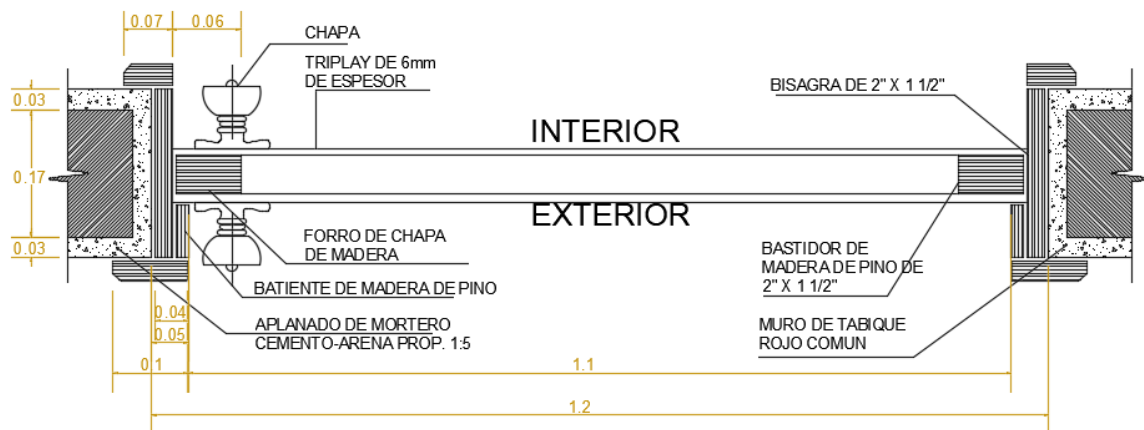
DIMENSIONES DE LA PUERTA PRINCIPAL.
